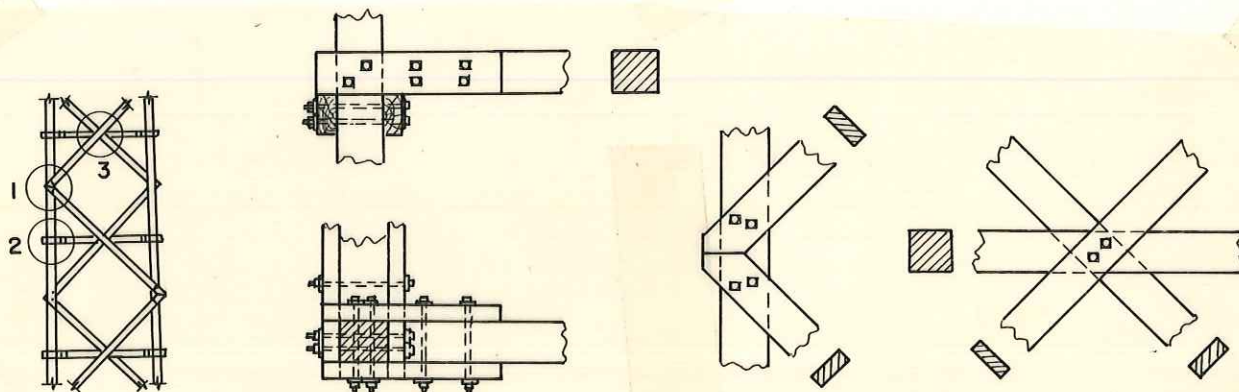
TORRE DE PEÇAS SERRADAS, DETALHES DE LIGAÇÕES
